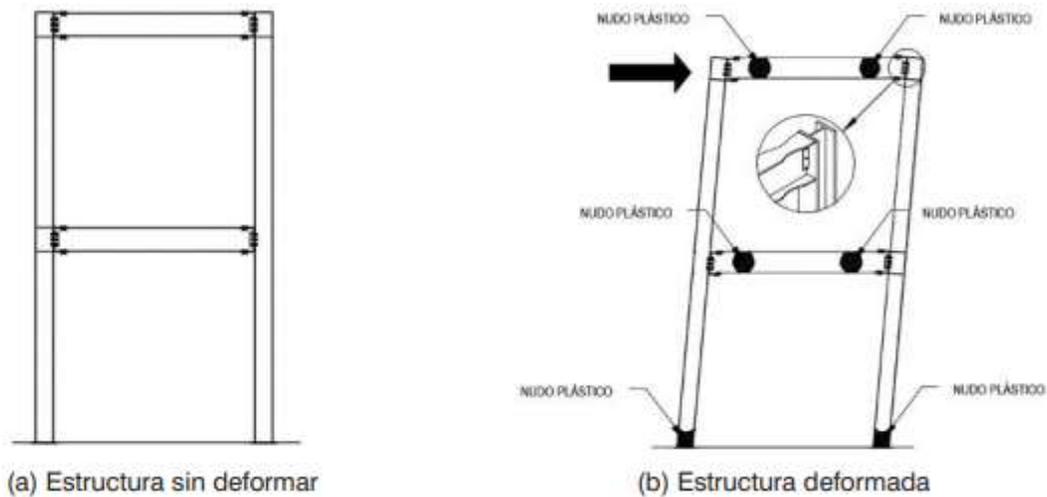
Sistema Estructural Mixto. Fuente: Moehle & Hooper, 2016.
